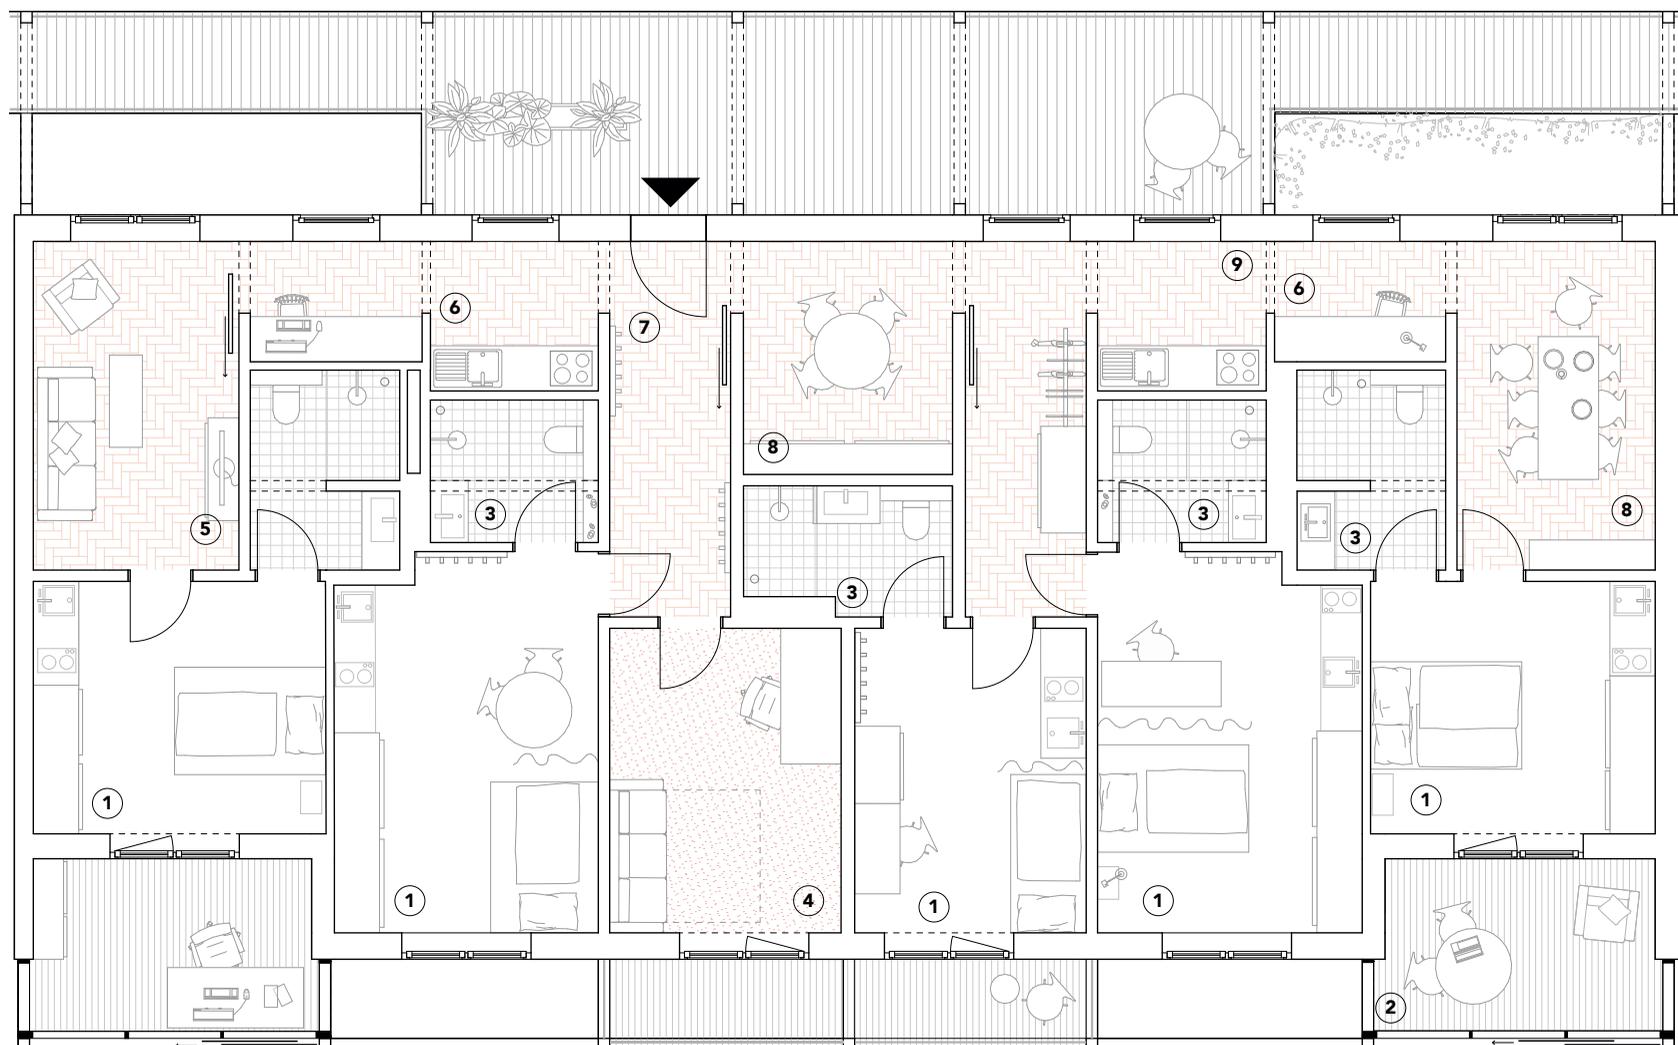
Grundriss Wohngemeinschaft M 1:100
